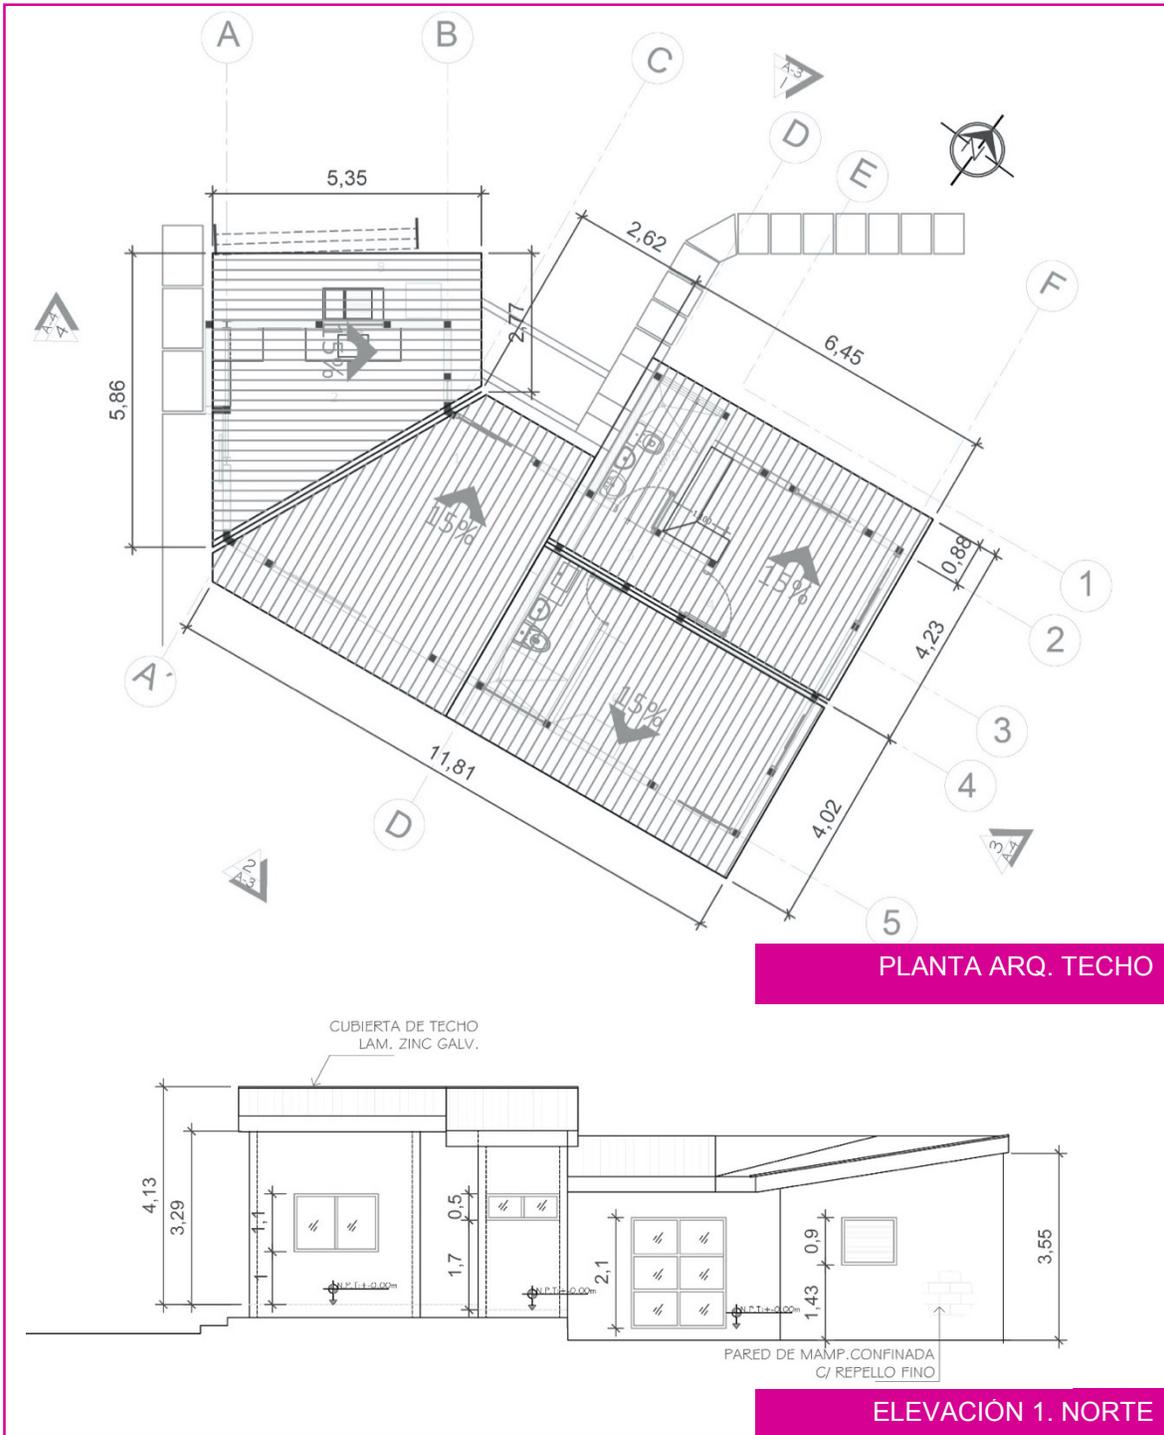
Planta Arq. Techo & Elevación Norte. Fuente: Autor. Programa Autocad.
